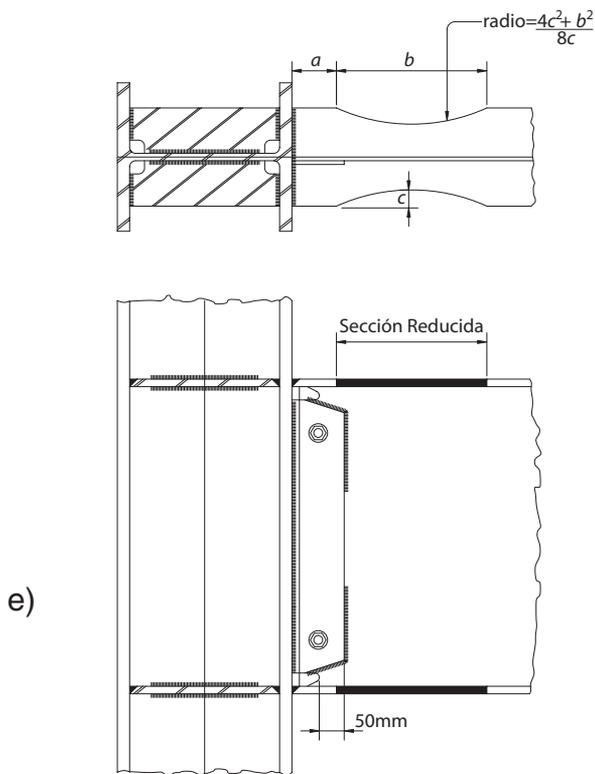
e. Uniones viga columna precalificadas, ref.8.
